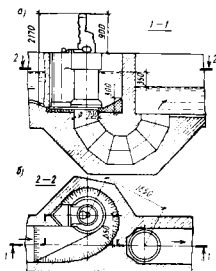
Схема установки решеточно-дробилки типа РД:
